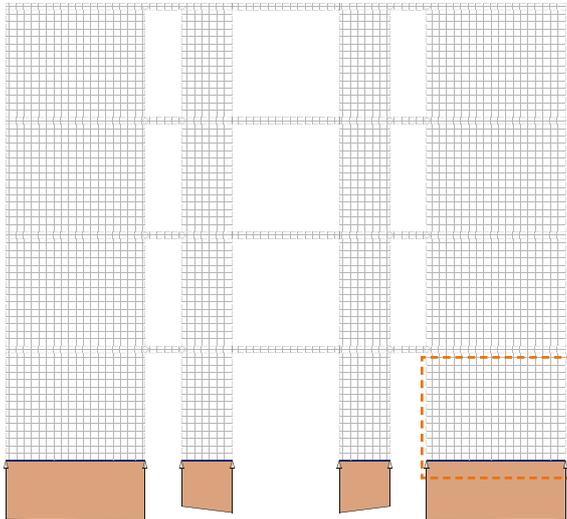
Verformungsbild FE-Modell ohne Deckenscheiben (Kragmodell), Lastfall 2: Horizontallasten (aus Wind)
